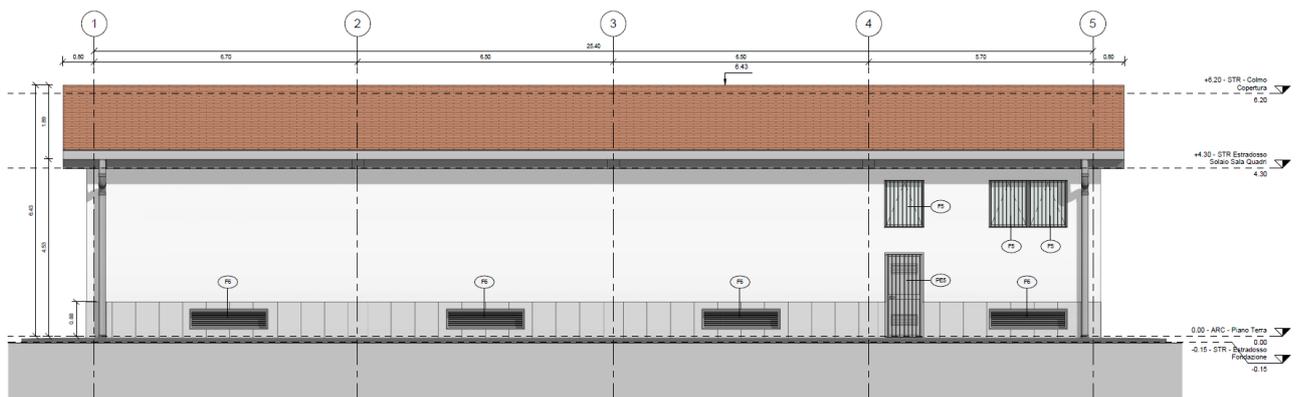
SSE Pieve Emanuele – Prospetto Sud
